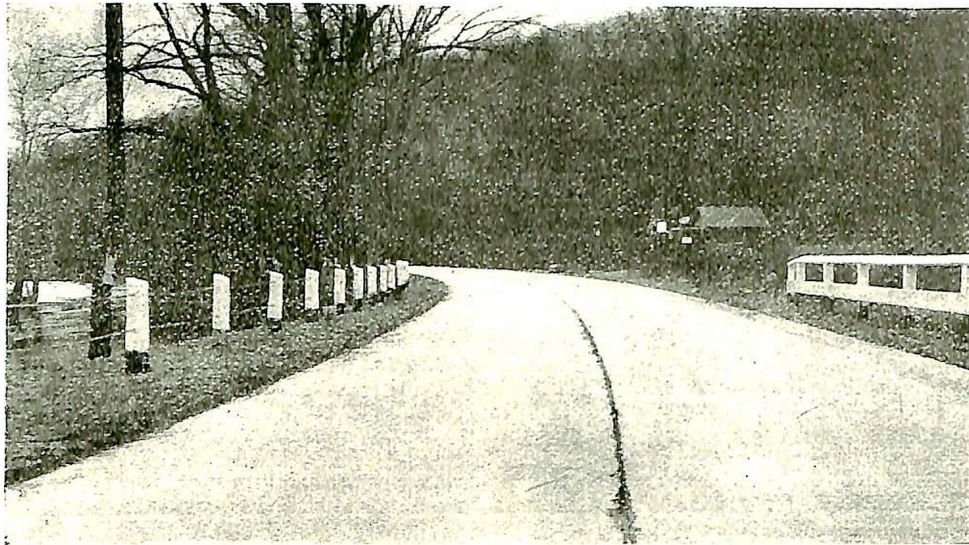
Betongvei Washington—Hackettstown, New Jersey, fullført 1924.
